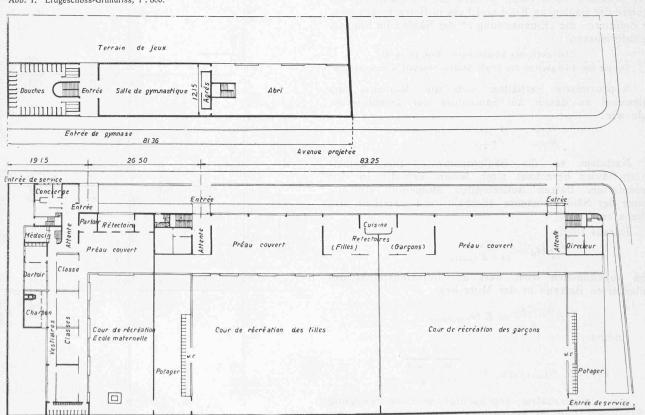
Erdgeschoss-Grundriss, 1:800.
